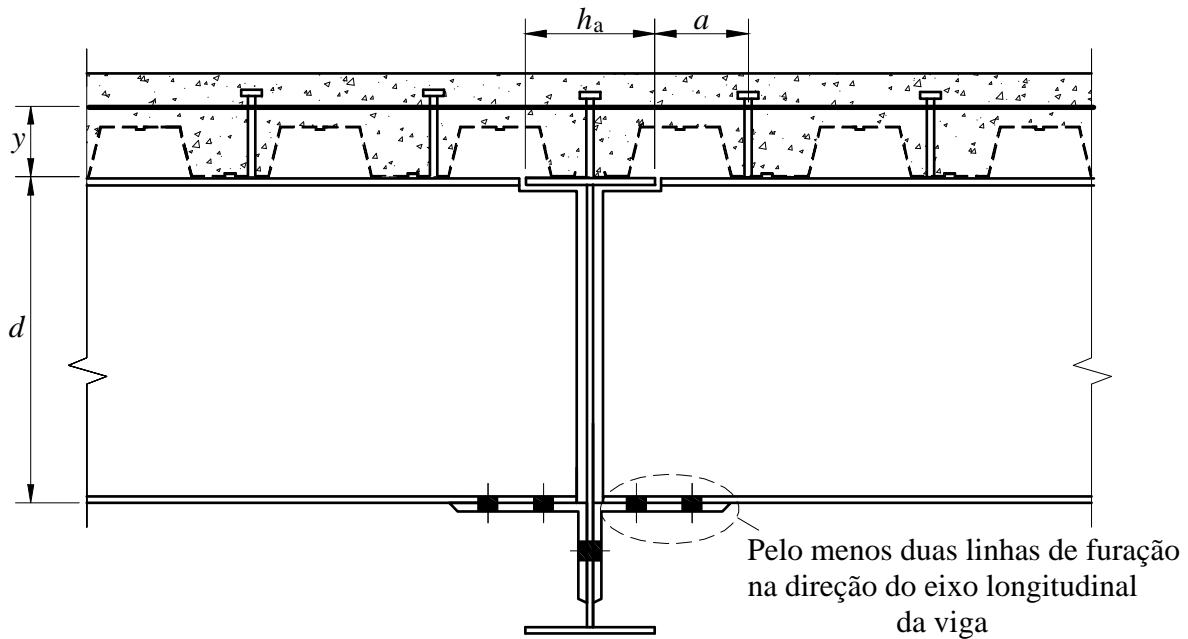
Ligação mista com cantoneira parafusada na mesa inferior da viga apoiada
